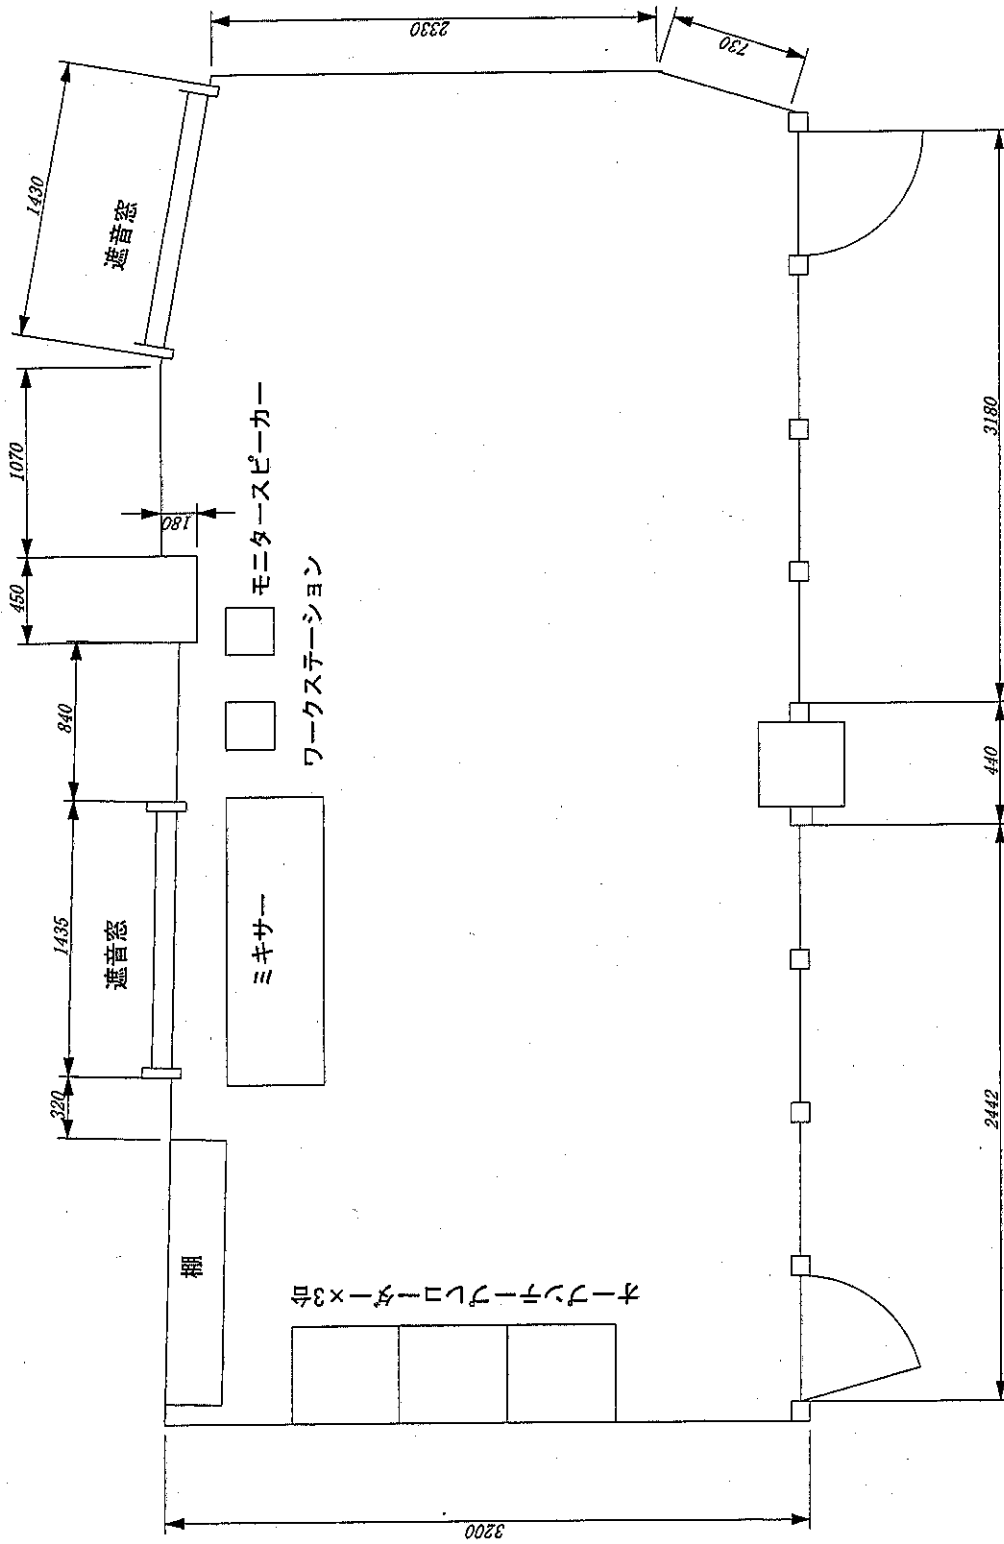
スタジオ機材設置予定平面図 (第13スタジオ)
